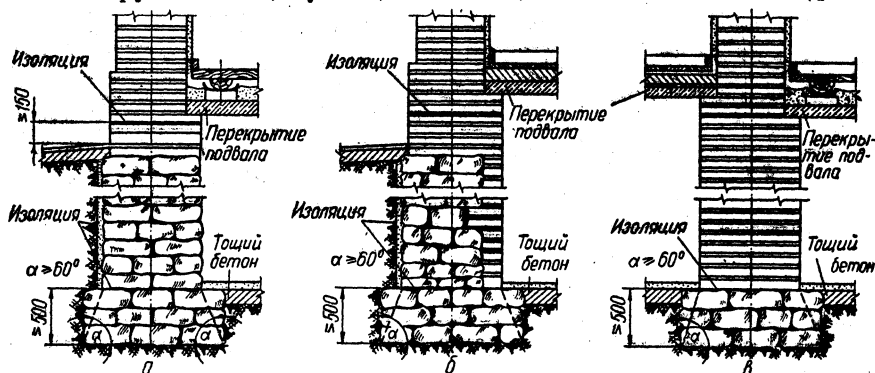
Бутовые фундаменты под стены зданий с подвалами:
